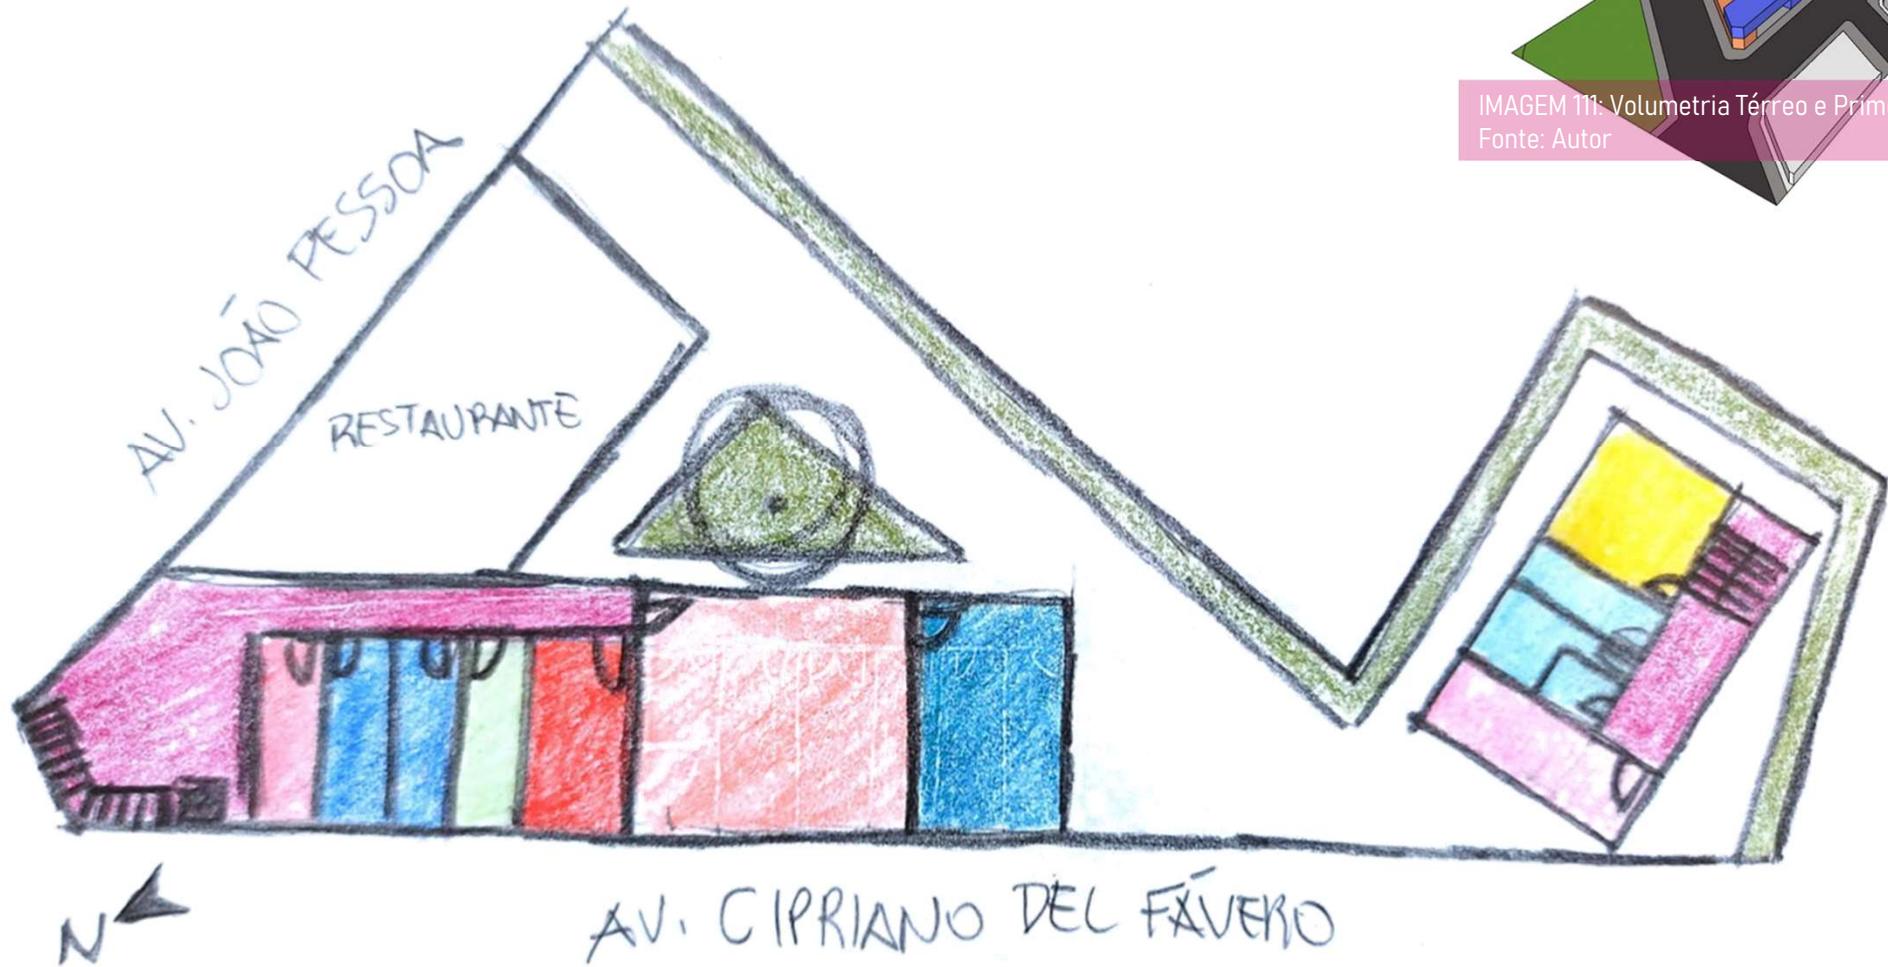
Volumetria Térreo e Primeiro Pavimento |
